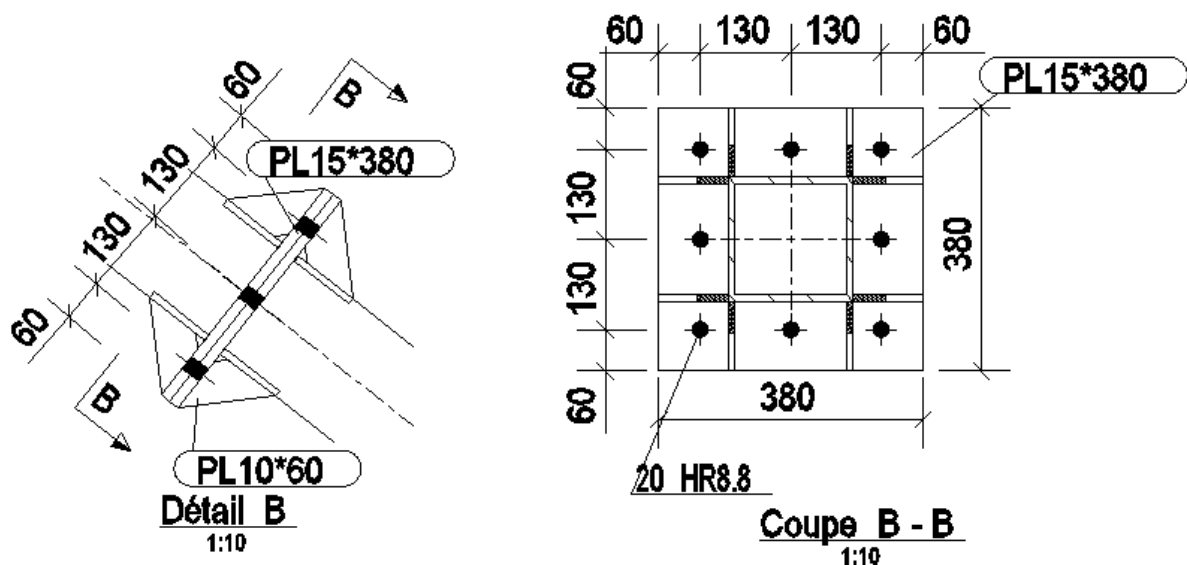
Coupe de l'assemblage (tube 180x180x10)
